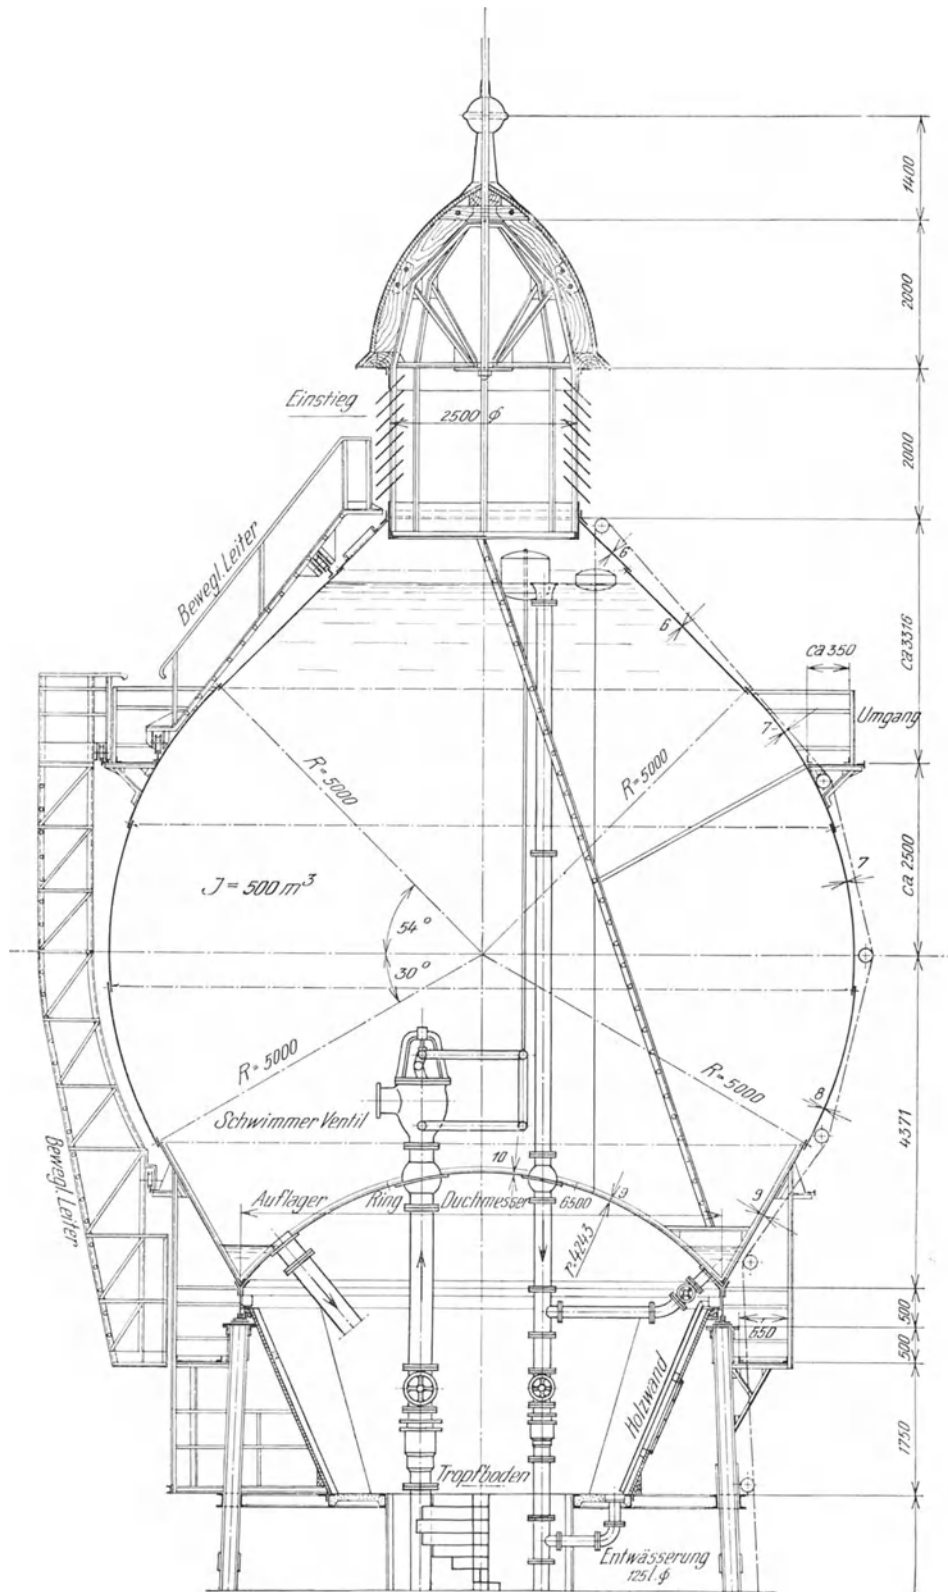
Kugelbehälter mit Intzeboden. (E. Wilke & Co., Braunschweig)
